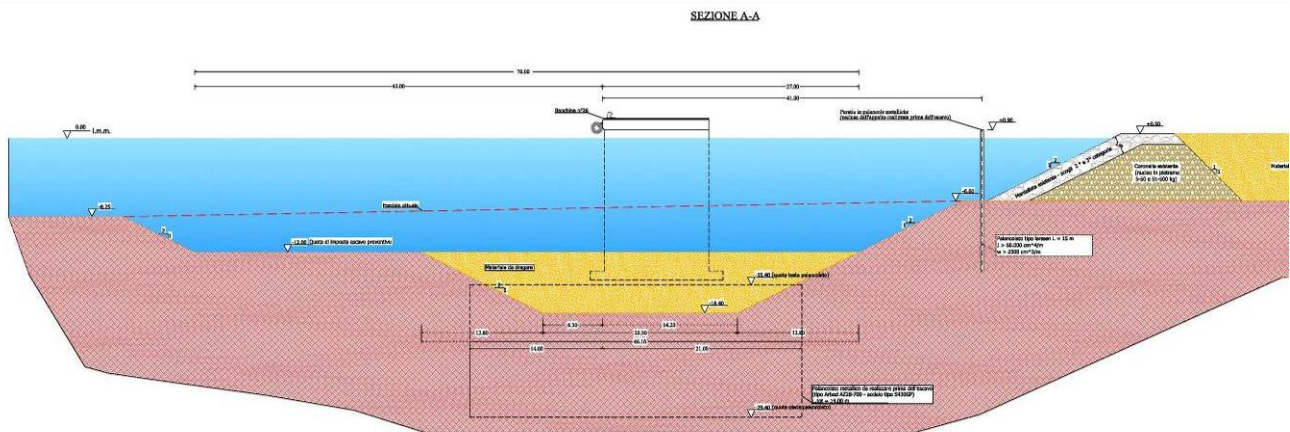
Sezione di escavo prevista in progetto esecutivo banchina 27
